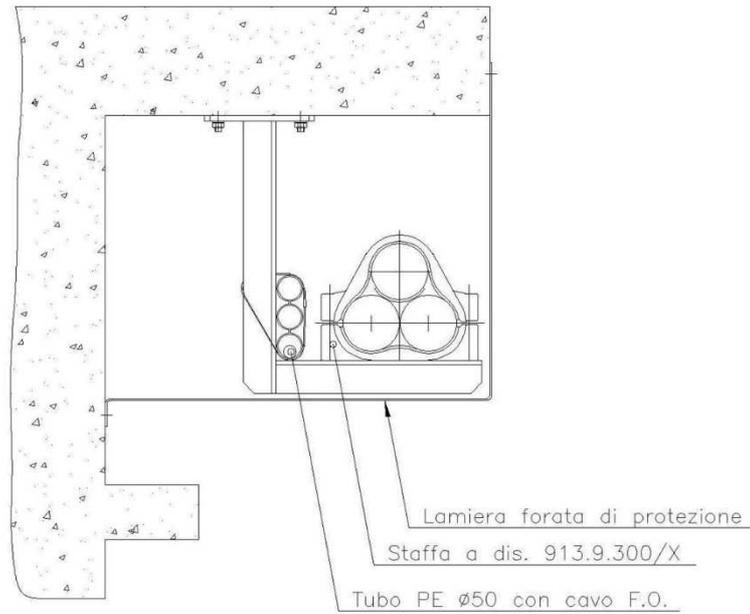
sezione tipo per staffaggio dei cavi sotto la soletta in cemento armato di un ponte
